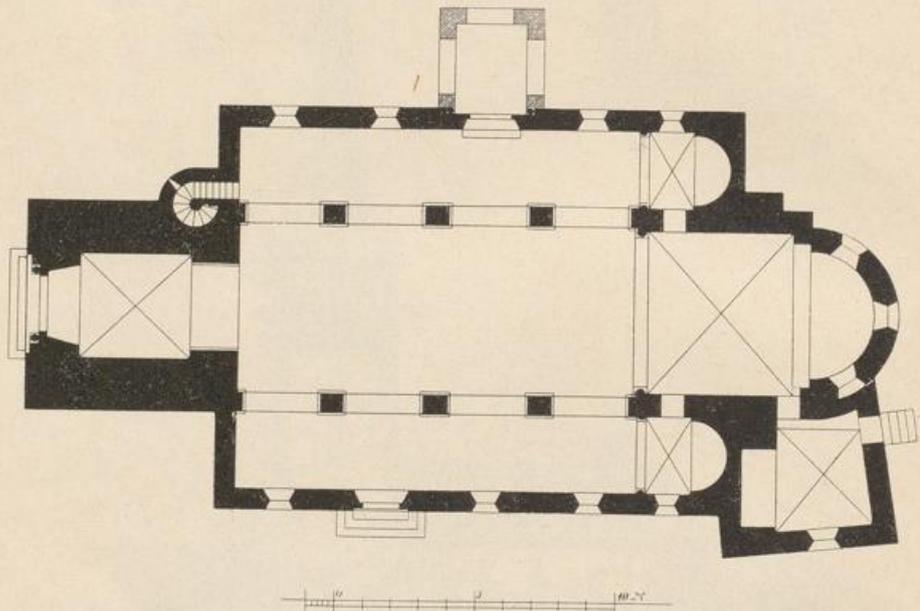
Overath. Grundriss der katholischen Pfarrkirche
